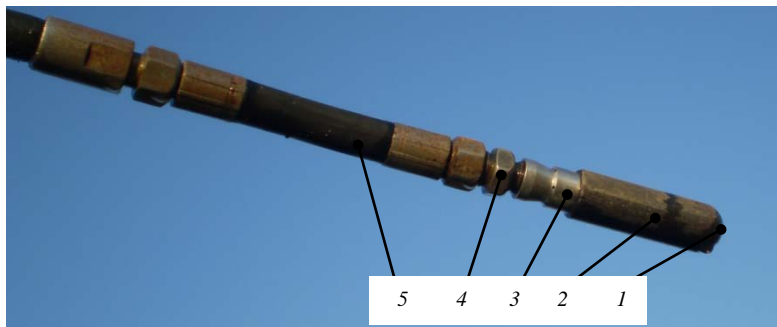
Дренопромывочная головка машины УПД-120, оснащенная излучателем сигнала: 1 – оголовок; 2 – излучатель сигнала; 3 – корпус головки; 4 – штуцер; 5 – присоединительный рукав
